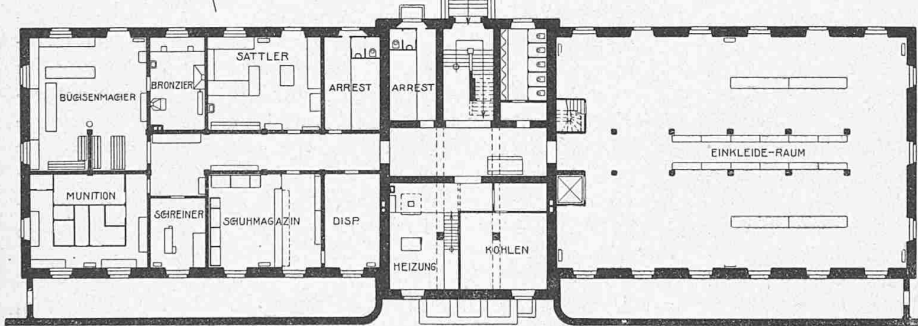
und 5. Grundrisse vom Untergeschoss und Erdgeschoss.
